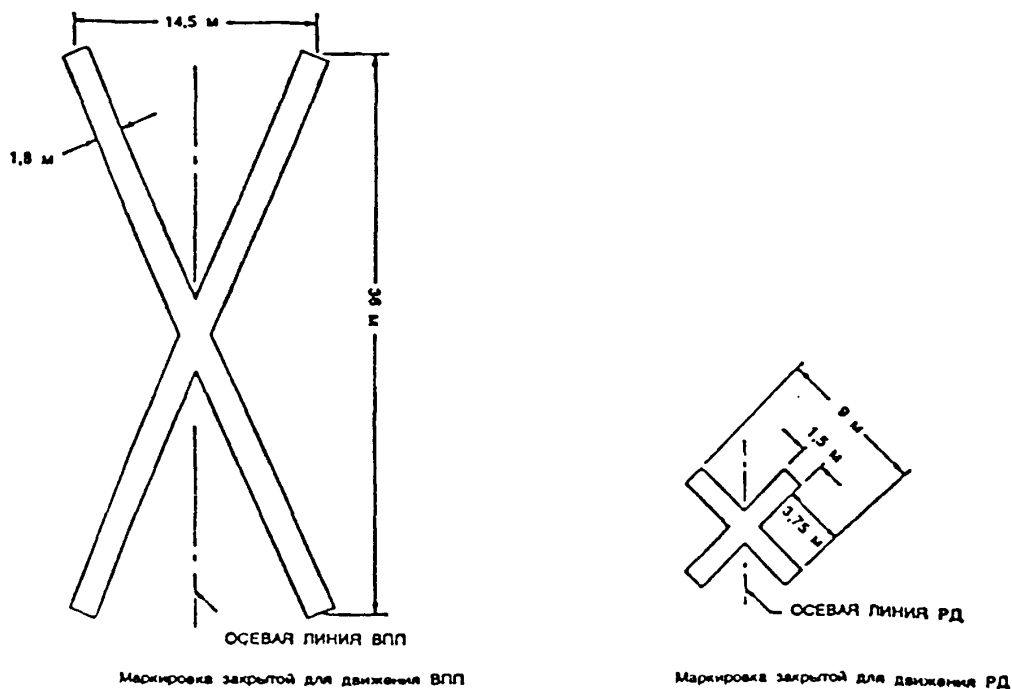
Маркировка закрытых для движения ВПП и РД.
